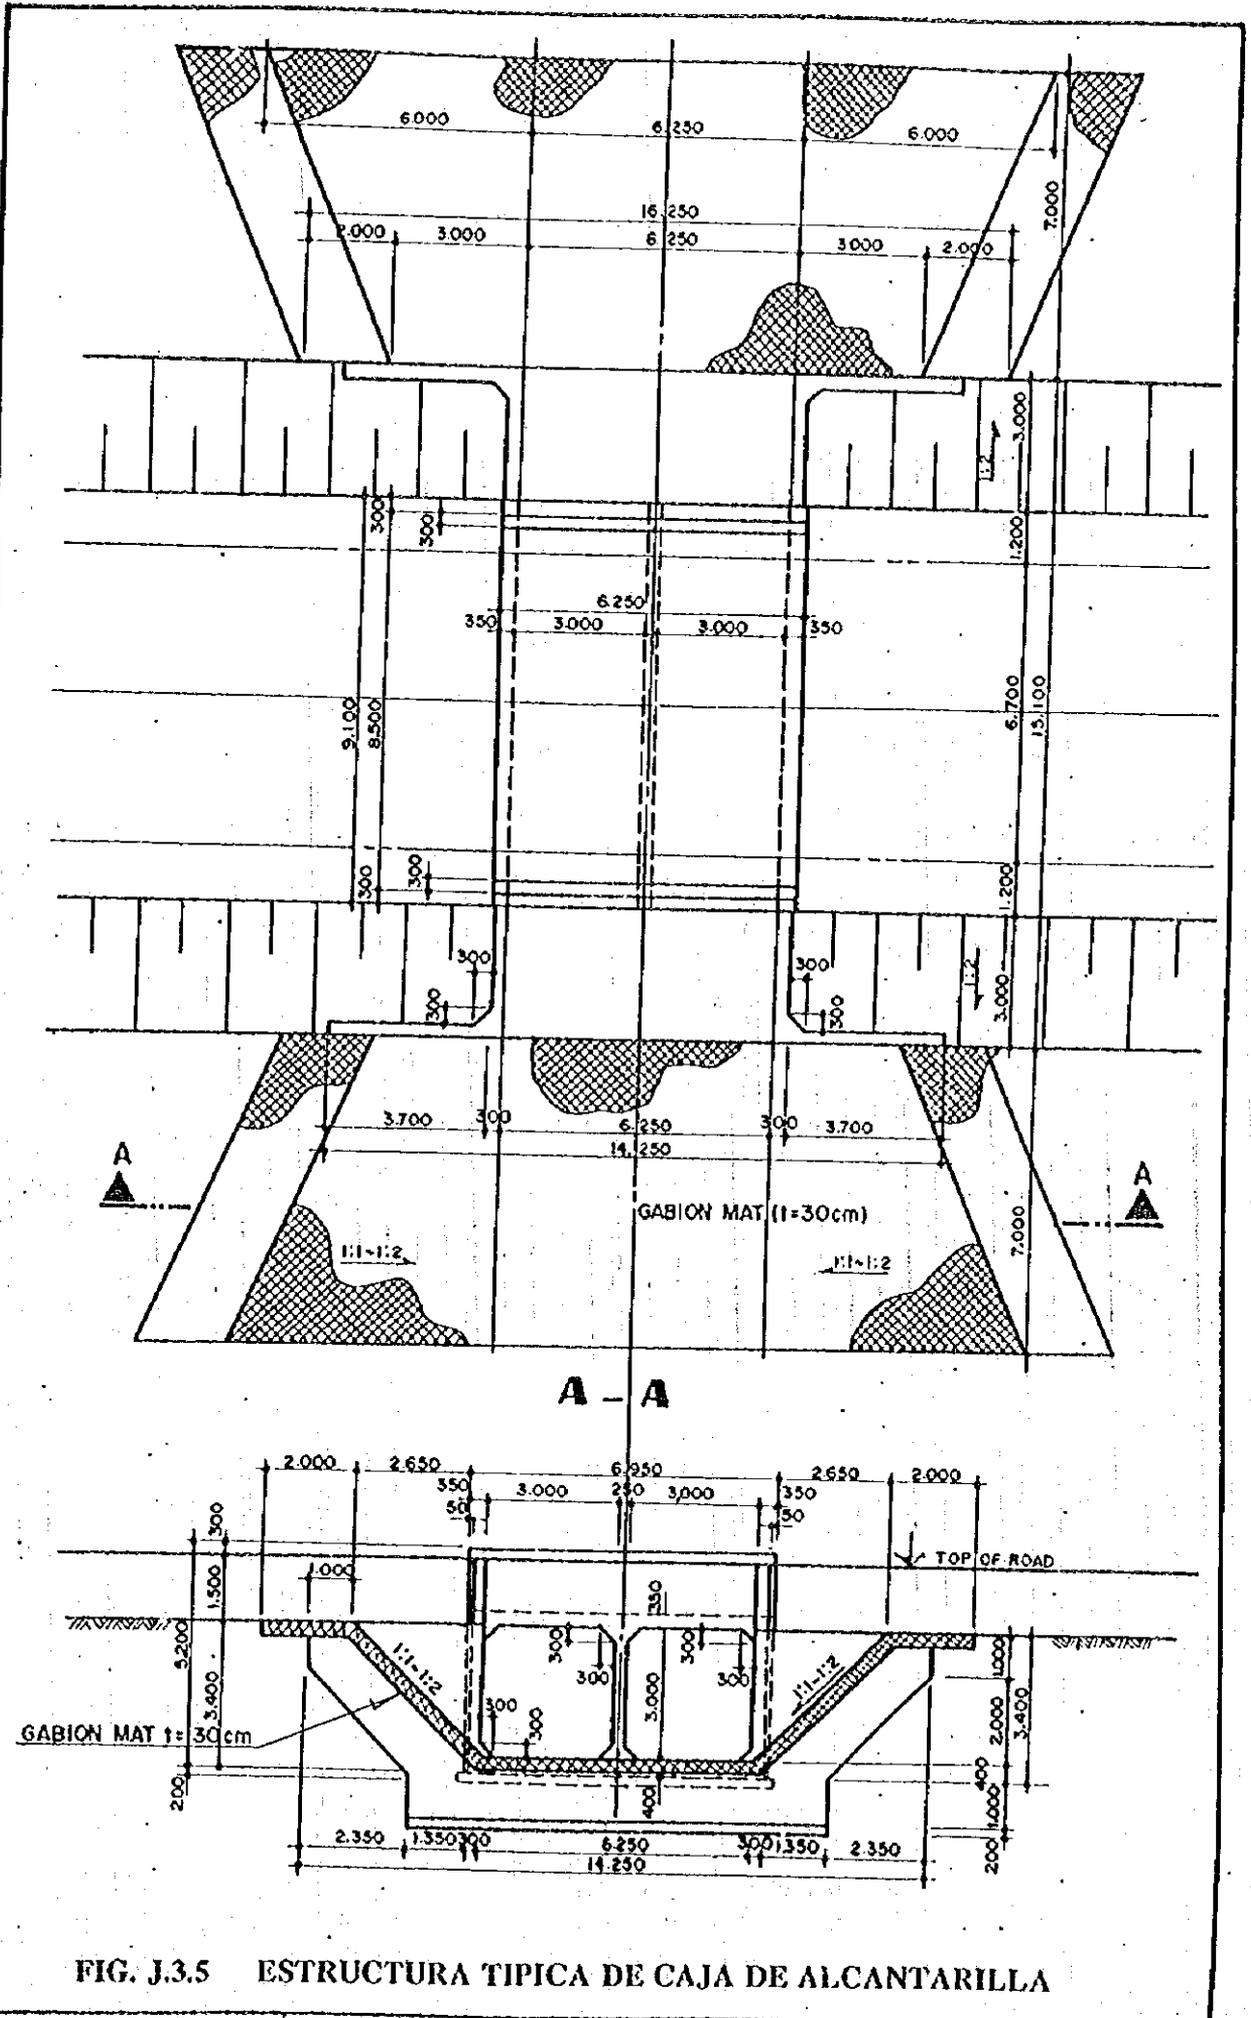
ESTRUCTURA TIPICA DE CAJA DE ALCANTARILLA
